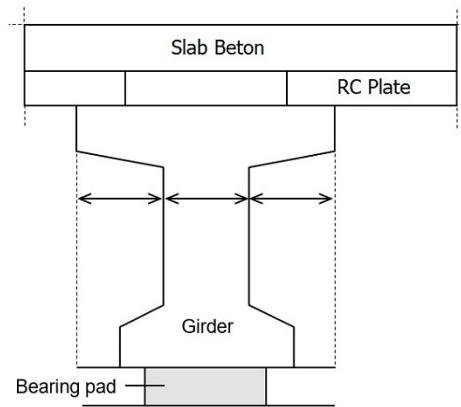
Permodelan Konstruksi Girder Komposit
